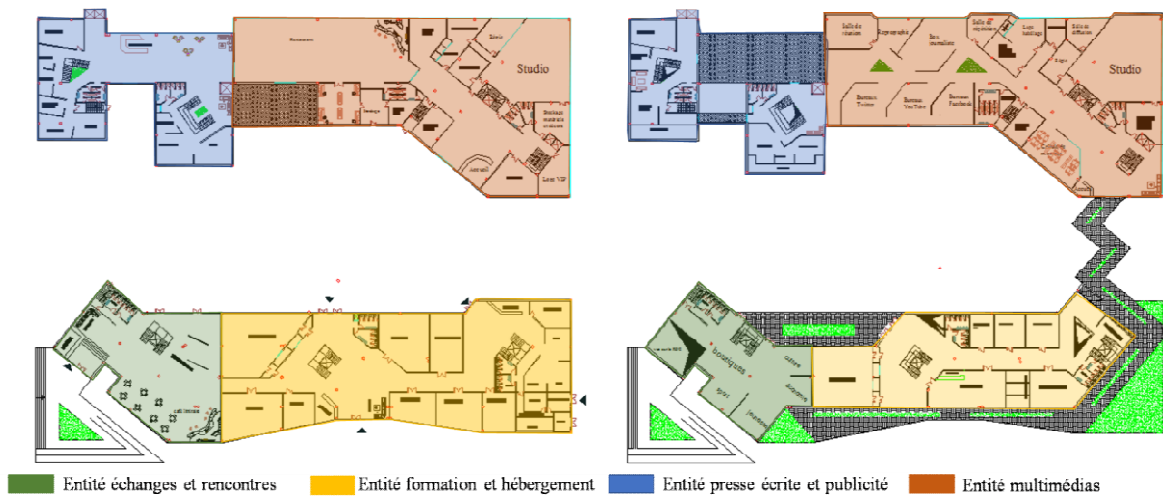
Plans du rez-de-chaussée. Source : Auteurs.
